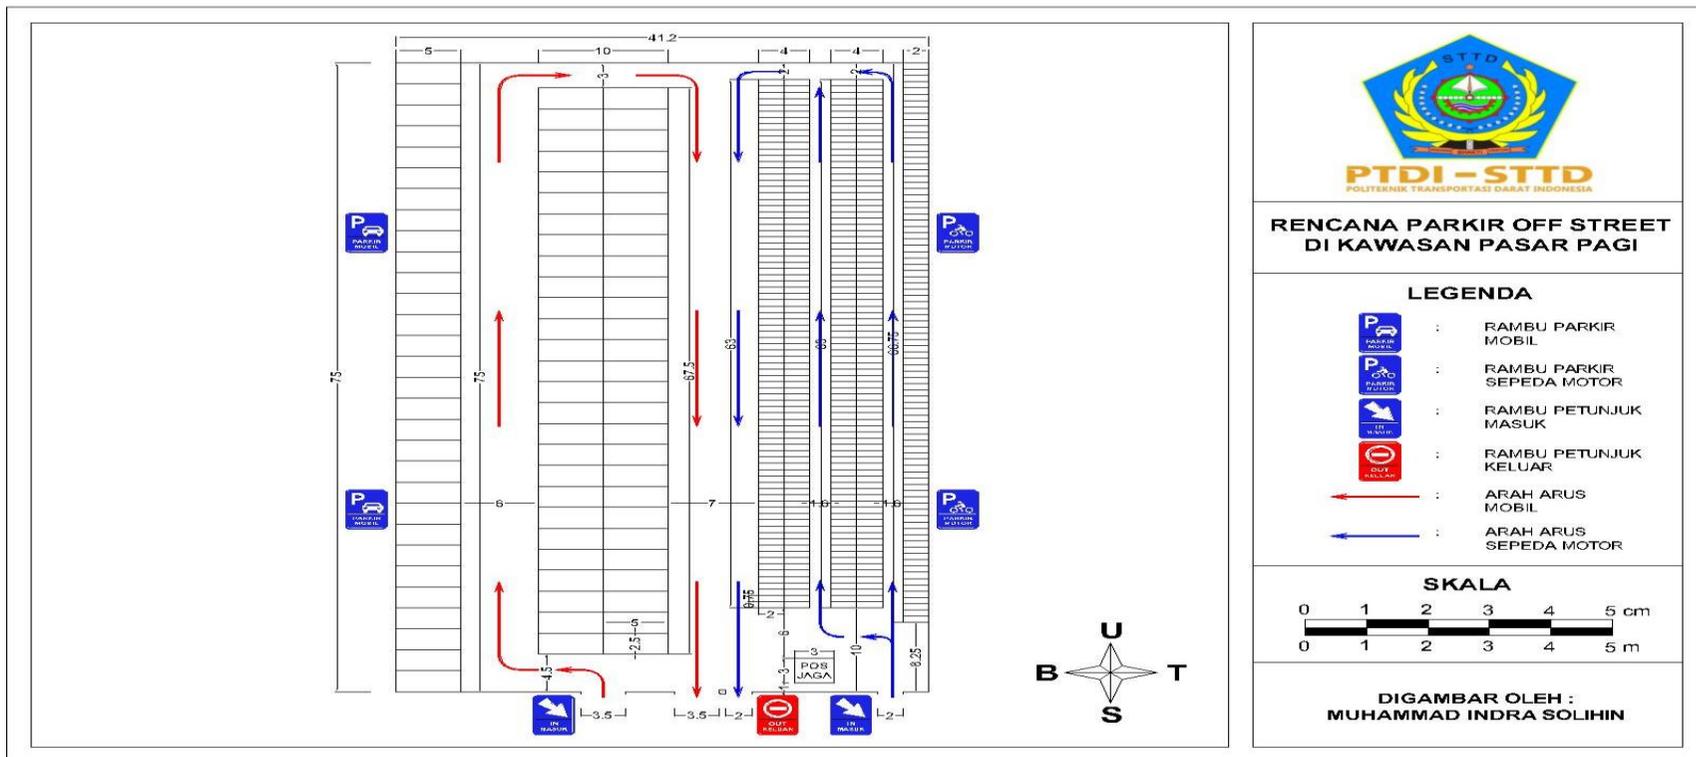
Rencana Lahan untuk Parkir Off Street
